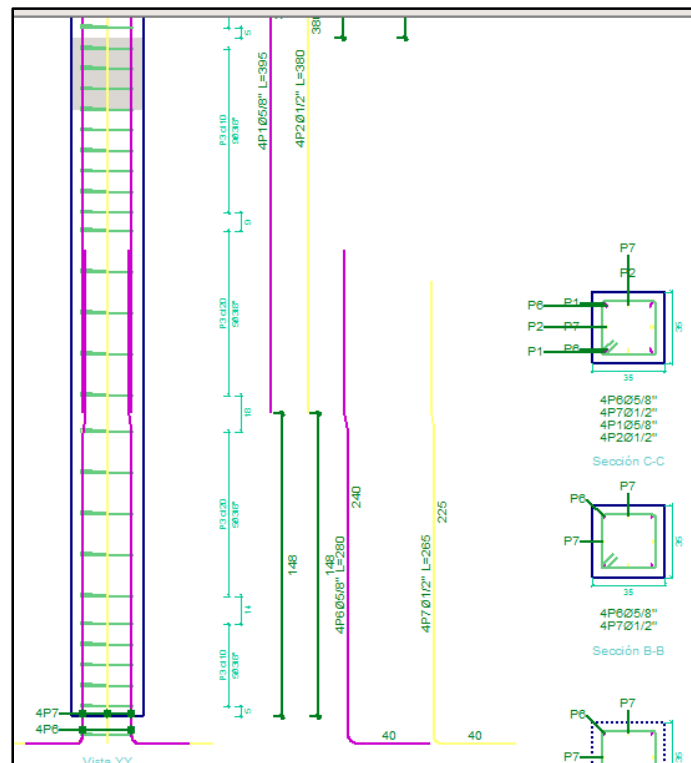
Despiece de columna con detallado correspondiente a estructuras DMO
